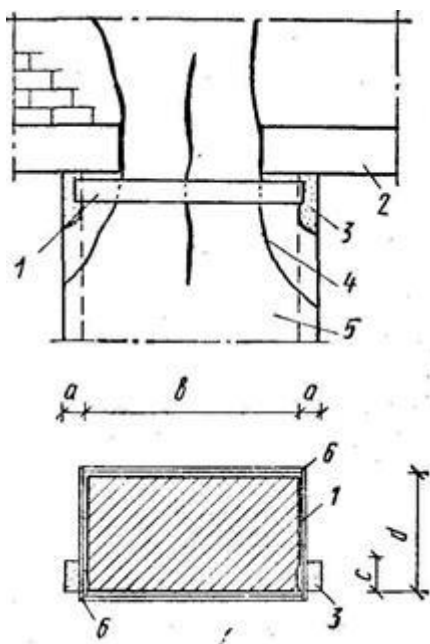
Усиление простенка стальным хомутом: 1 - хомут из полосовой стали 6х60 (80) мм; 2 - перемычка; 3 - заделка цементным раствором М100; 4 - трещина; 5 - простенок; 6 - сварка
